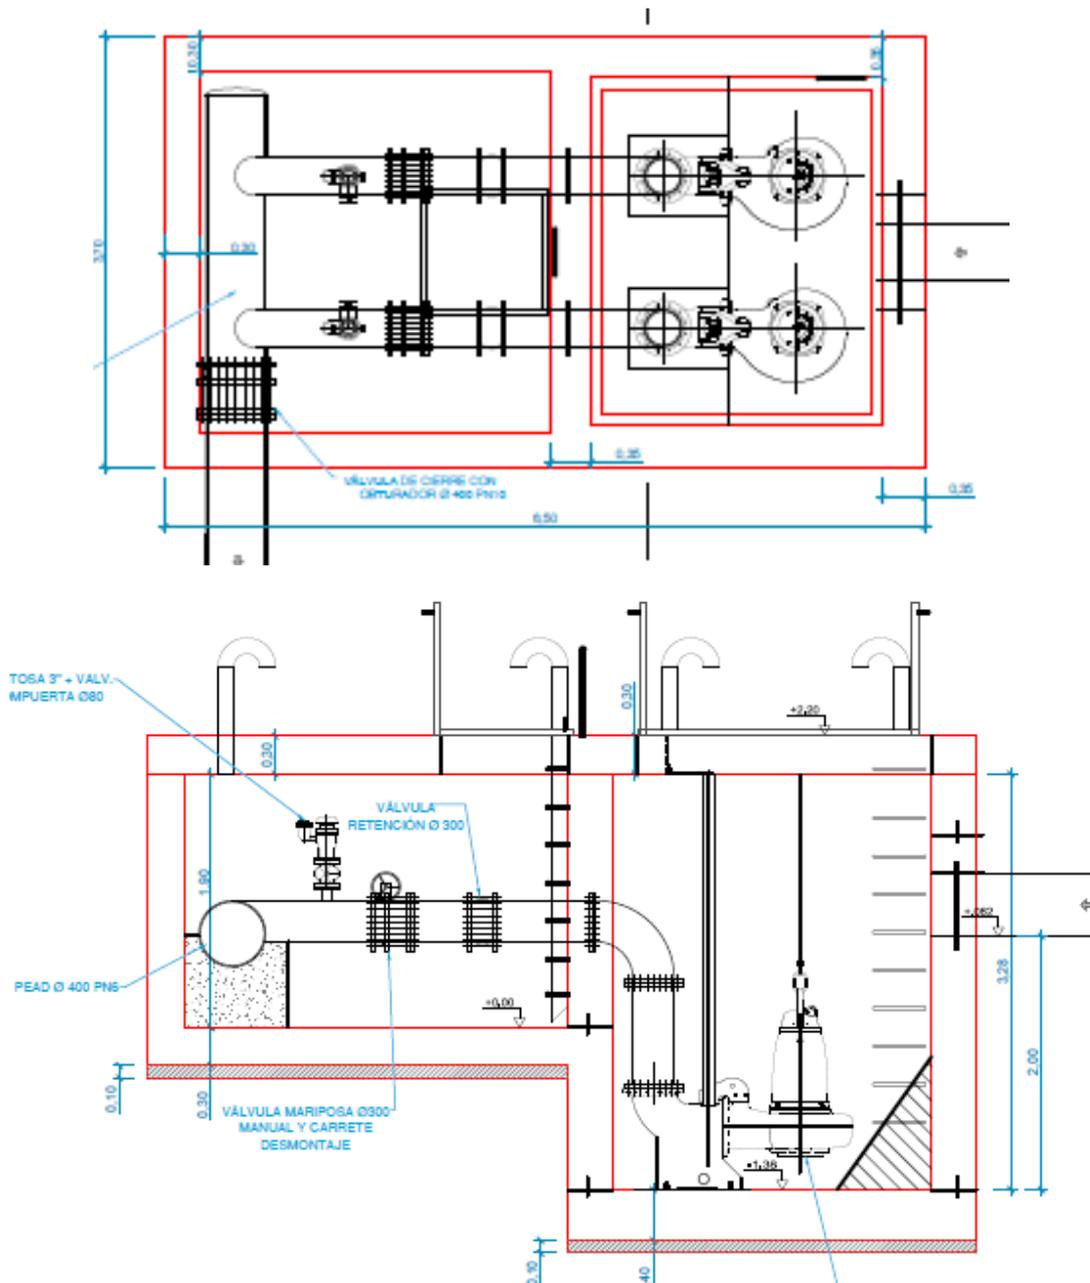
Planta y sección. Arqueta bombeo y cámara de llaves.
